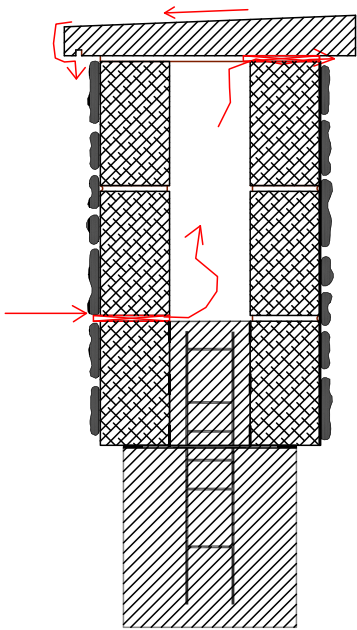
Vista de la fachada en el lugar de las juntas de dilataci on.
